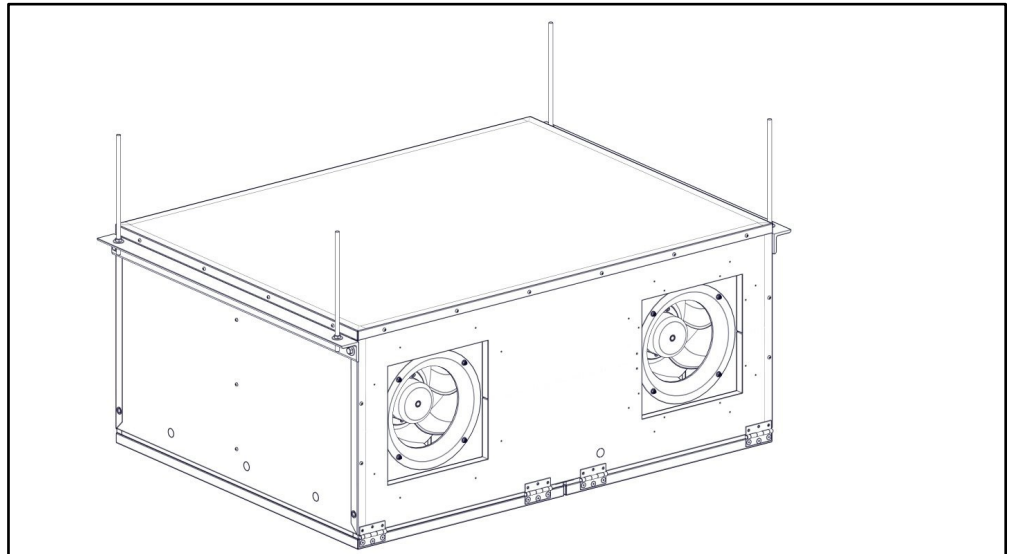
AUTRE DISPOSITIF D'ACCROCHAGE AU PLAFOND
